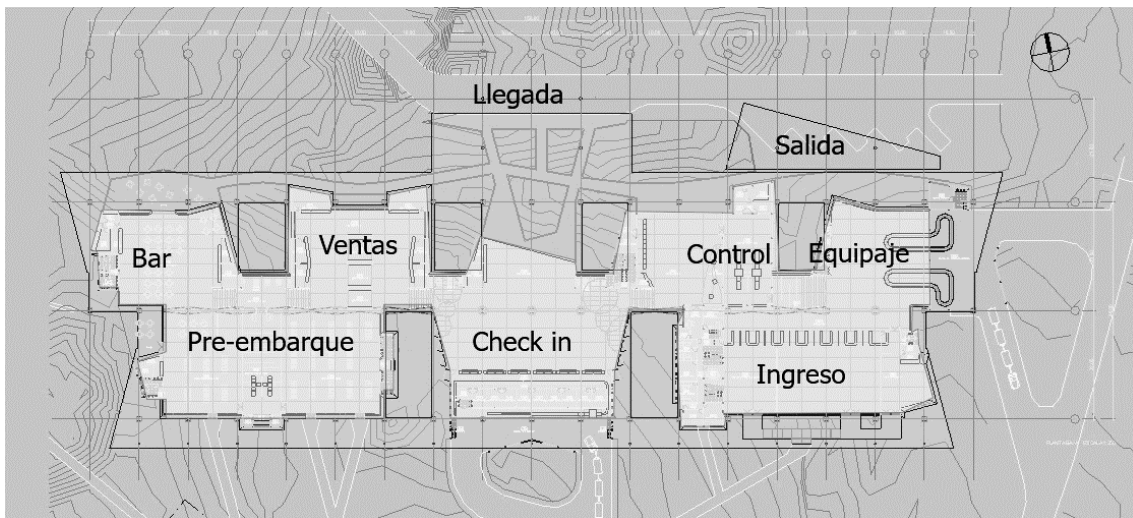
Planta de la Terminal de Pasajeros, con patios, limitadas fachadas orientadas al este y oeste, potenciando las fachadas abiertas a los vientos predominantes del sudeste.
